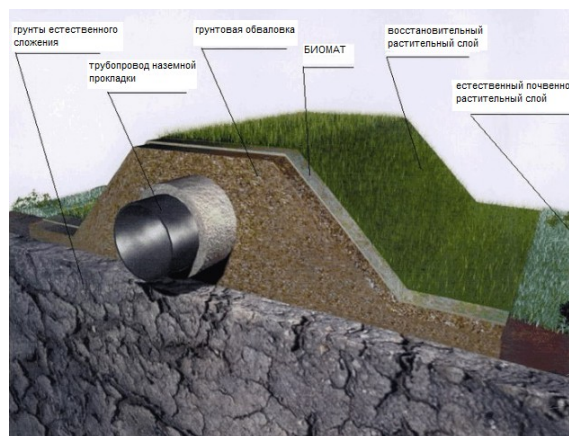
Закрепление биоматов на трубопроводах наземной прокладки
